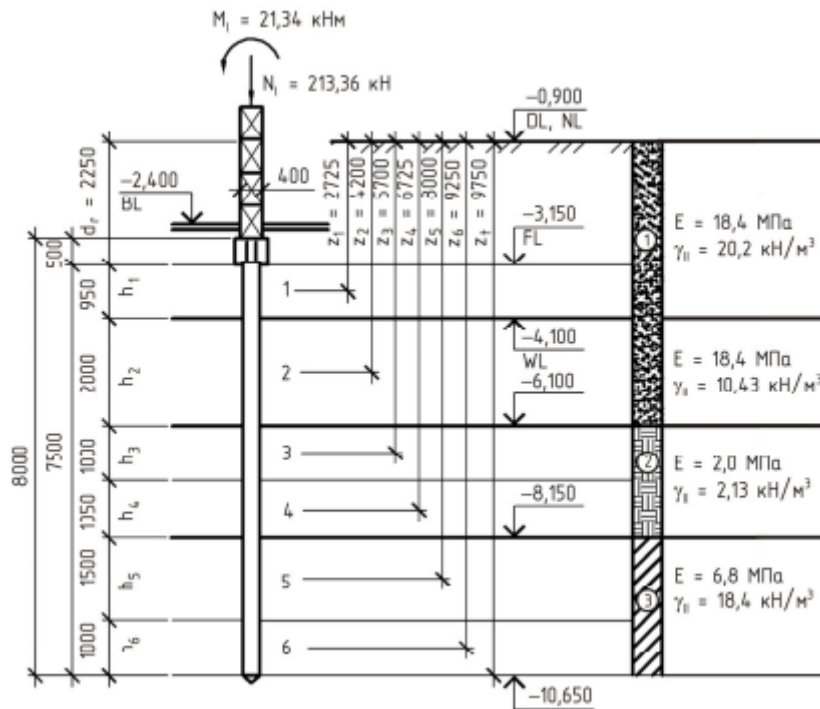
Расчетная схема к примеру со свай С80.30
